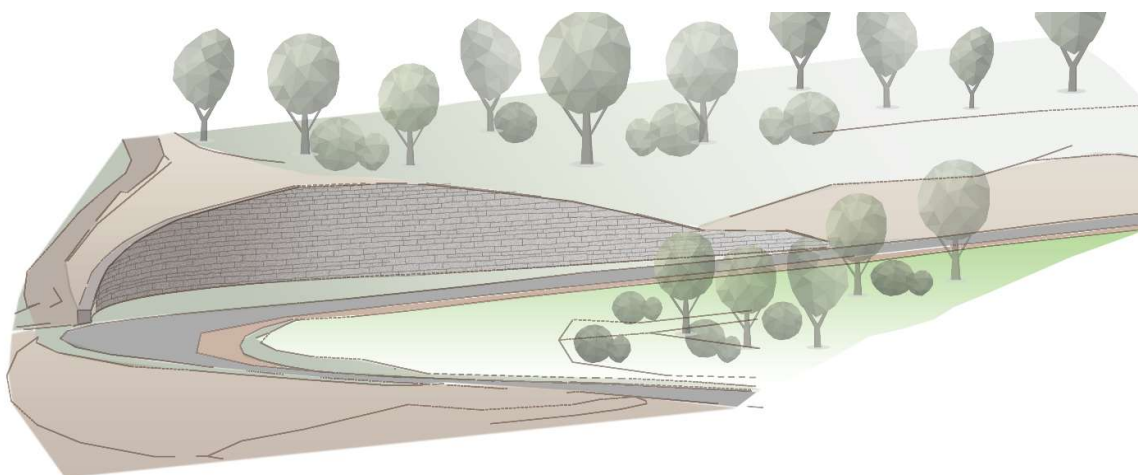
Vista prospettica dell'OB.42 (Vista 1)
